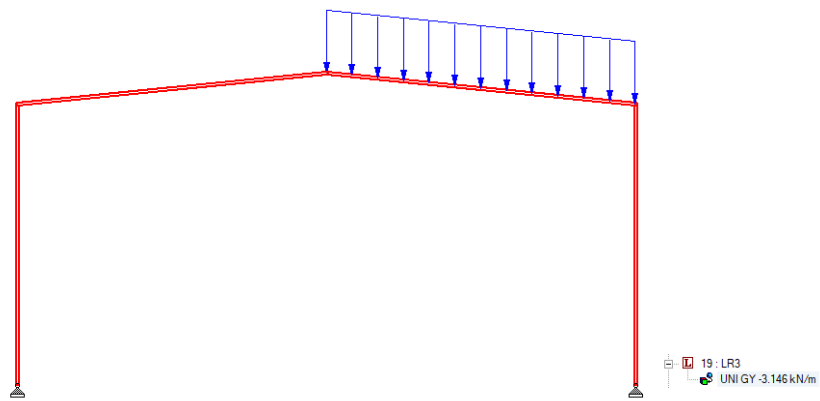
Sobrecarga de cubierta Lr3 del pórtico. Fuente: elaboración propia.
